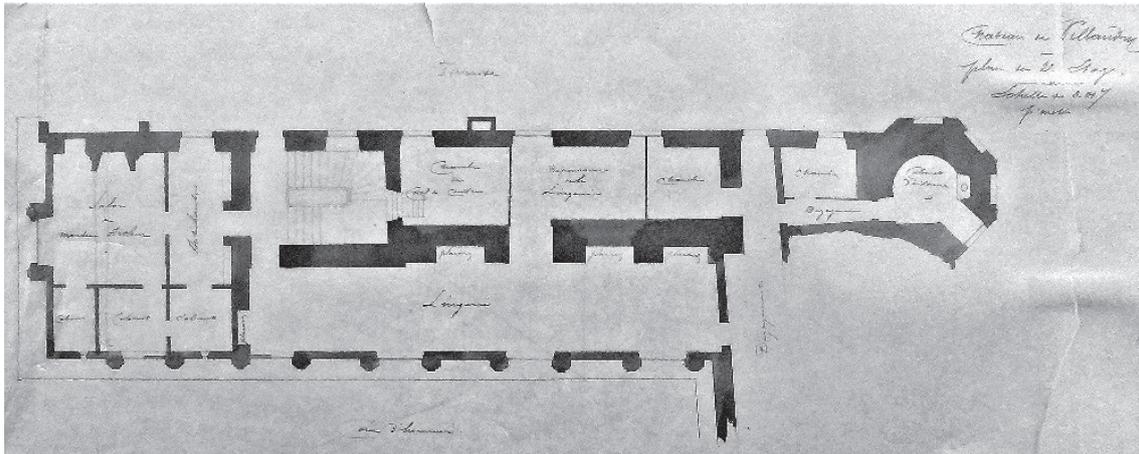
Plan de l'aile gauche du château au second étage, fin XIX^e siècle (AD 37, 29 J 2202).
